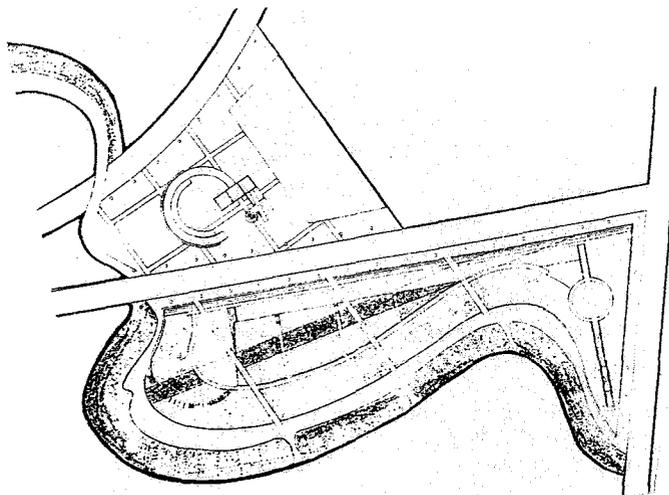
Jardim dos Bambus. Alexandre Chemetoff. Paris. 1982. Planta Baixa.
